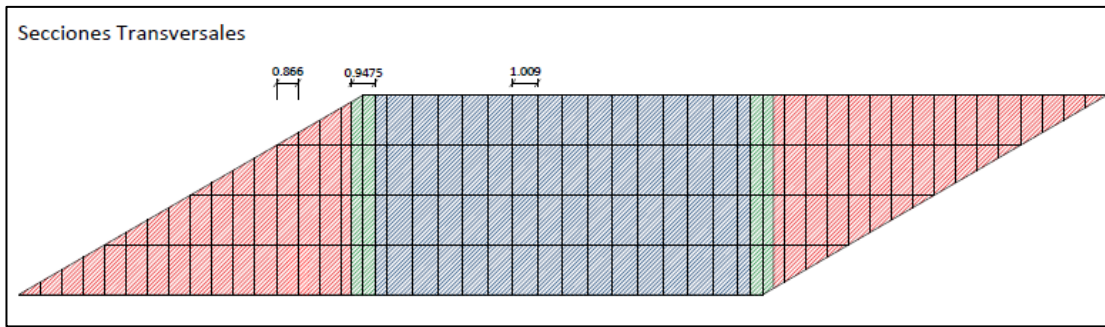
Detalle sobre las diferentes secciones transversales.
